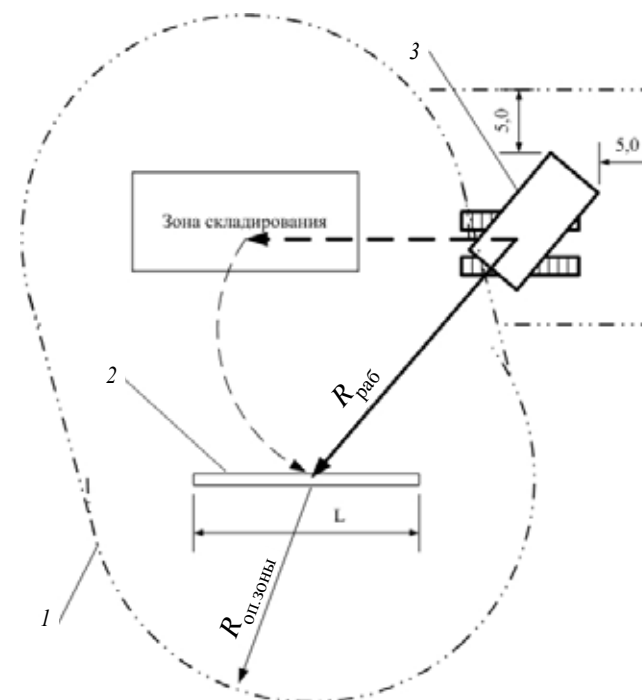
Расчетная схема определения опасной зоны при перемещении груза краном: 1 – граница опасной зоны; 2 – перемещаемый груз; 3 – грузоподъемный кран
